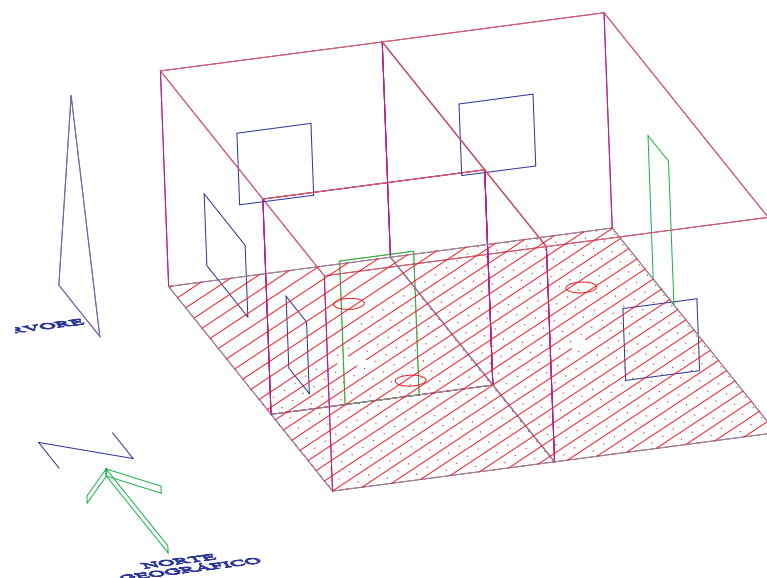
Casa Original com Árvore – Estudo de Caso 2 – Planta Baixa
